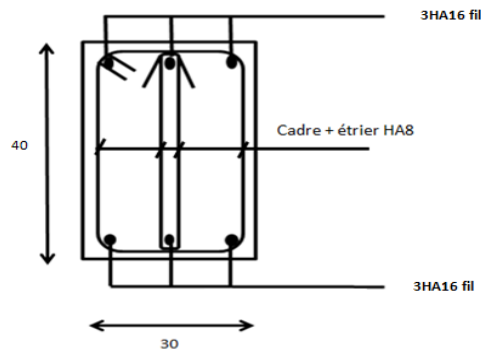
Ferrailage en travée d'une poutre principale.
